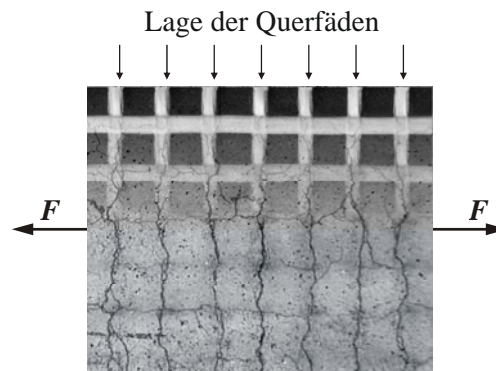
Rissbildung einer textilbewehrten Betonprobe unter einaxialer Zugbelastung
